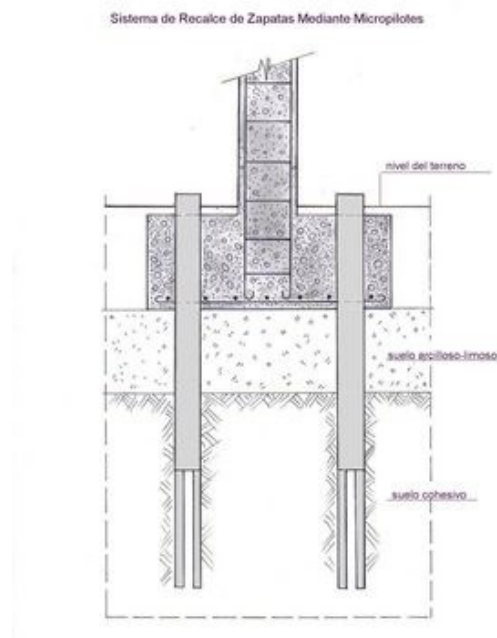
Construmatica, (2008). Recalce de zapatas mediante micro pilotes, Esquema, Tomado de <https://www.construmatica.com/construpedia/Archivo:Sistema-de-Recalce-de-Zapat.jpg>
